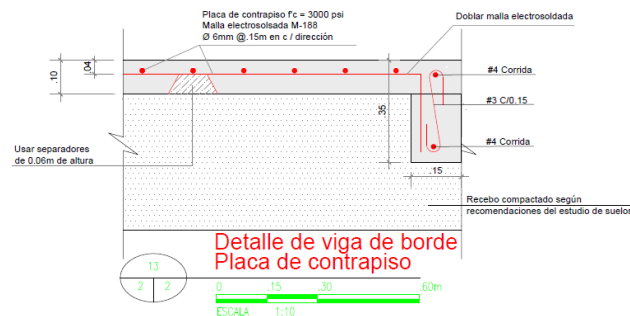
Detalle de Viga; Fuente: Planos de Diseño Nuevas Tecnologías.
